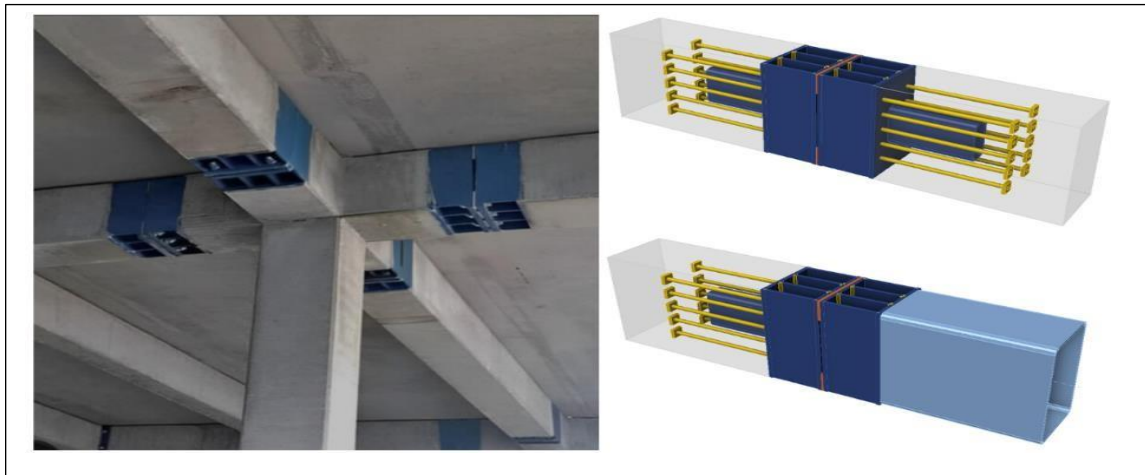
Systèmes d'assemblages poutres-poutres en béton préfabriqué[28].
